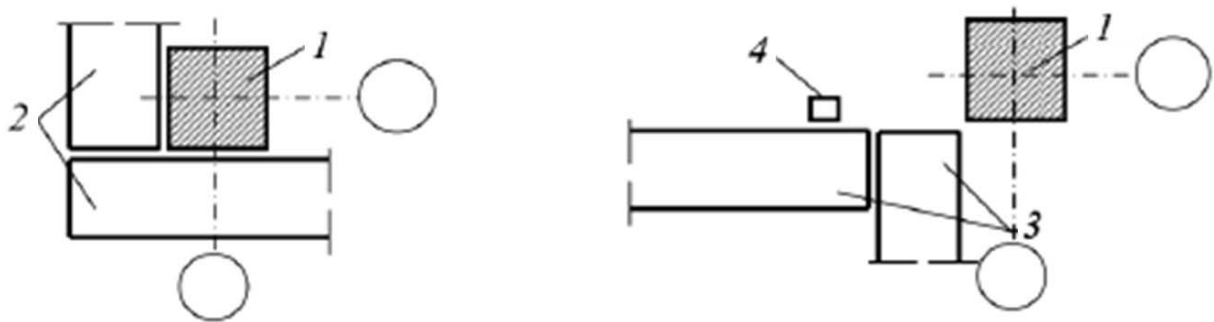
Схема устройства стеновых панелей каркасно-панельного здания
